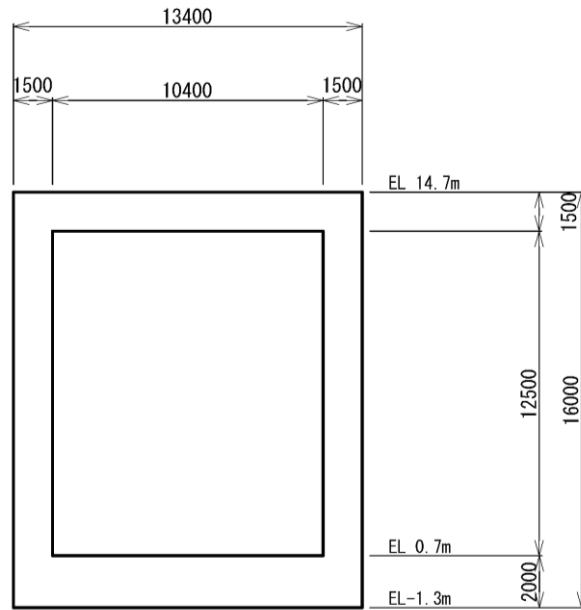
低圧原子炉代替注水ポンプ格納槽 平面図
